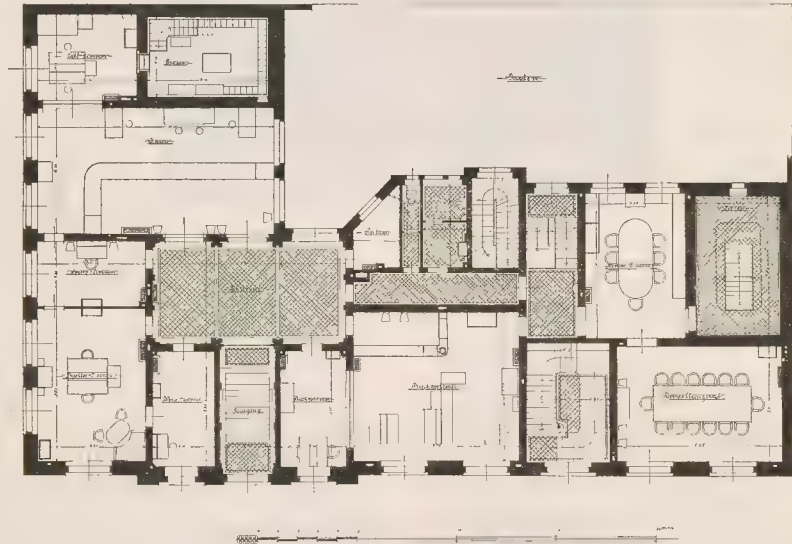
Br.-Hannov. Hypoth.-Bank zu Hannover. Grundriss des Erdgeschosses.
